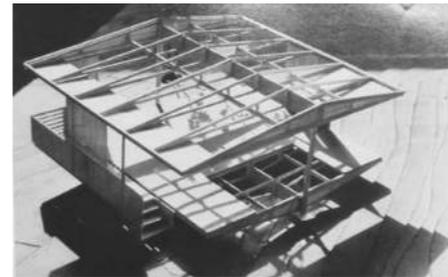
Maqueta del modelo Plas -2 Points. Muestra entramado de cubierta y piso, sistema estructural creado con principios de reducción de costos y fácil montaje.
